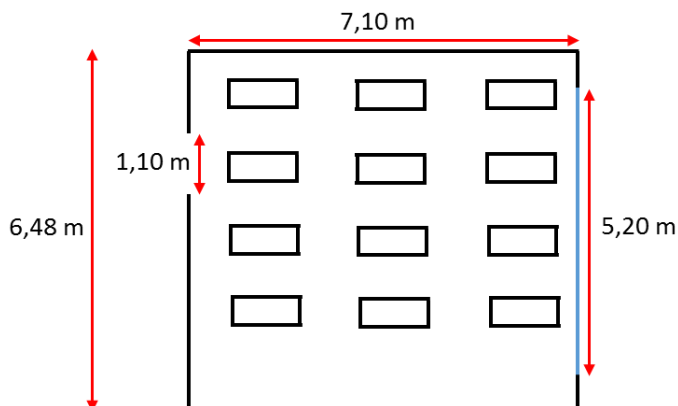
Schema planimetrico dell'aula al primo piano dell'IC di Pellezzano - Plesso Scuola Primaria sito in via della Quercia a Capezzano (Pellezzano – SA)
